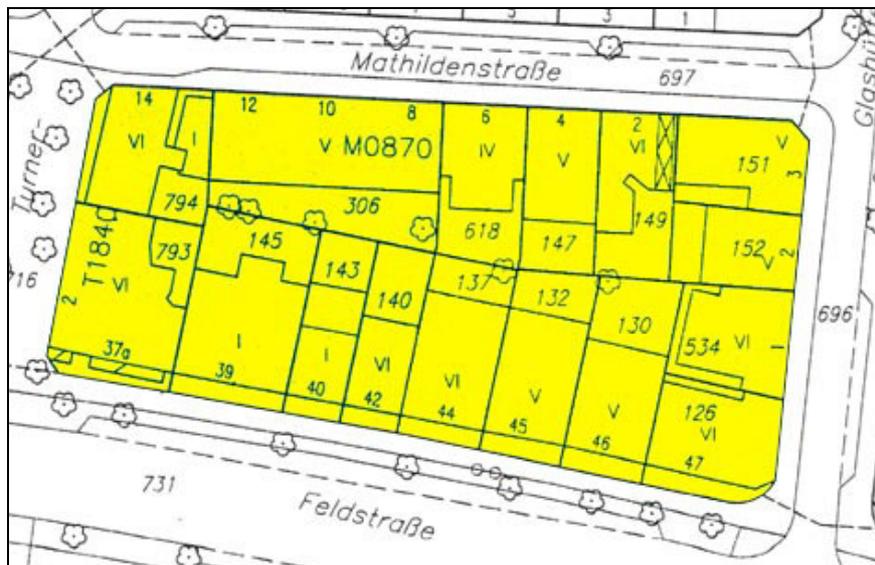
Lageplan Modell 2 RWNA des geteilten Systems
